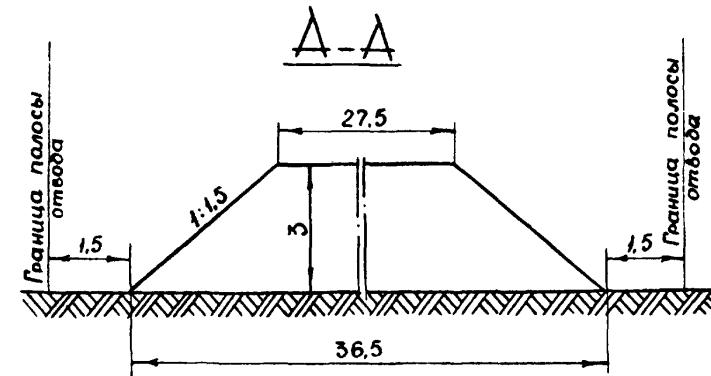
Схема отсыпки грунта при возведении насыпи дорожного полотна
